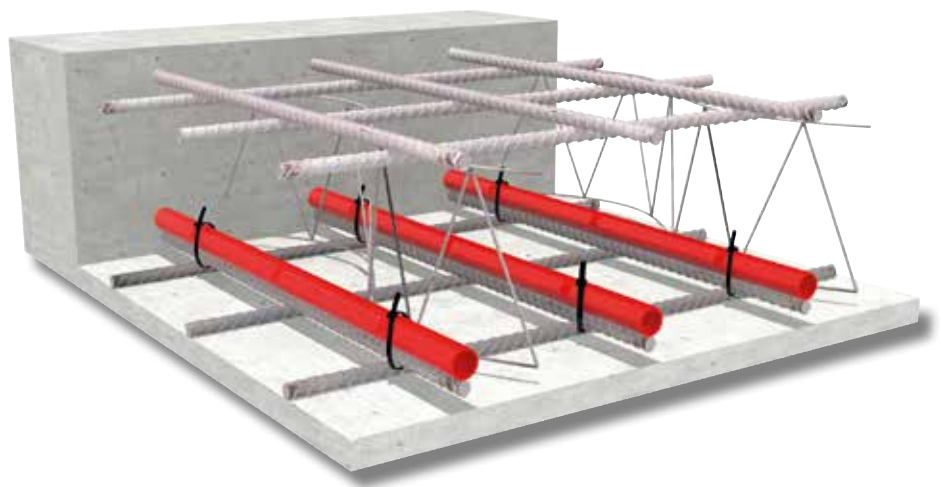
| Schemaskizze Bauteilaktivierung einer Geschoßdecke. © Z + B
